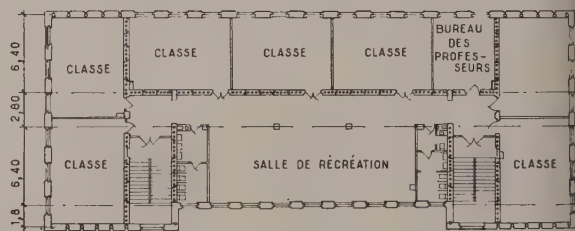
Plan-type de l'étage d'une école réalisée en éléments préfabriqués.
